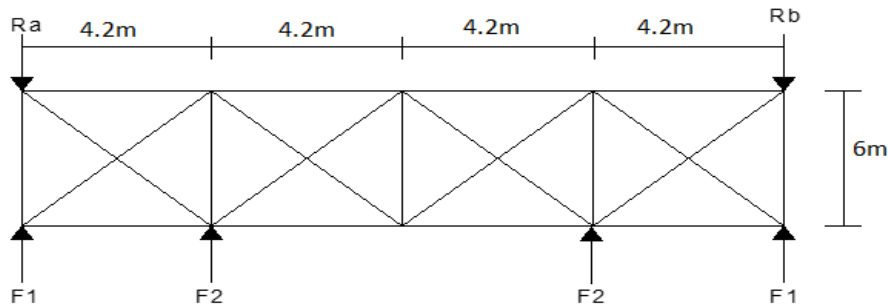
Schéma de la poutre au vent de pignon.
